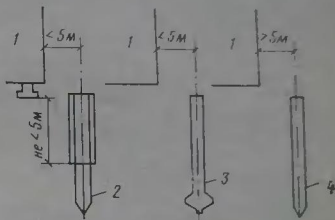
Схема расположения свай вблизи существующих зданий 1
